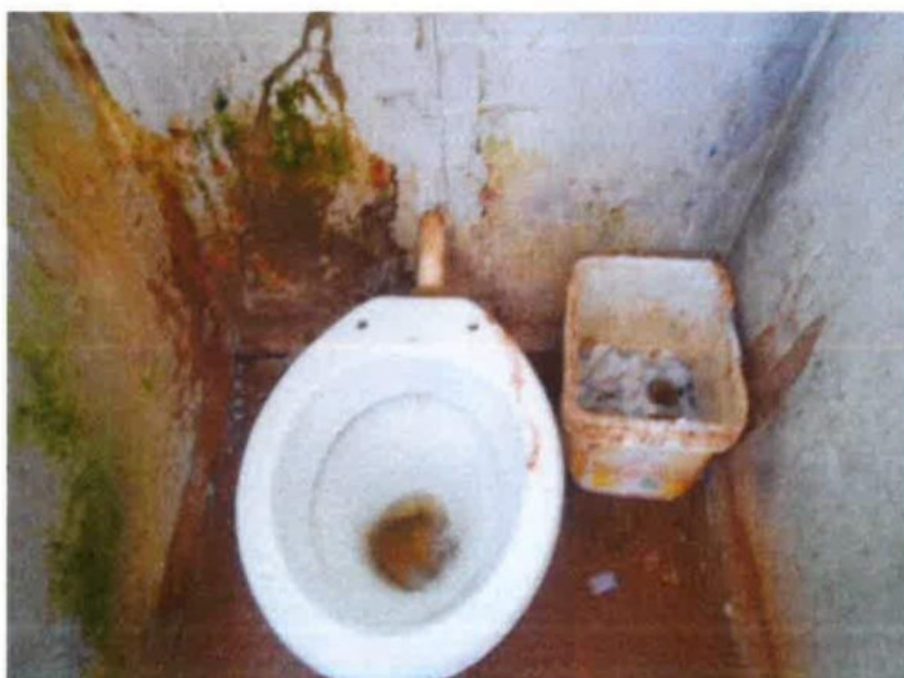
Banheiro da área externa do alojamento. Utilizado nos dias de visita
